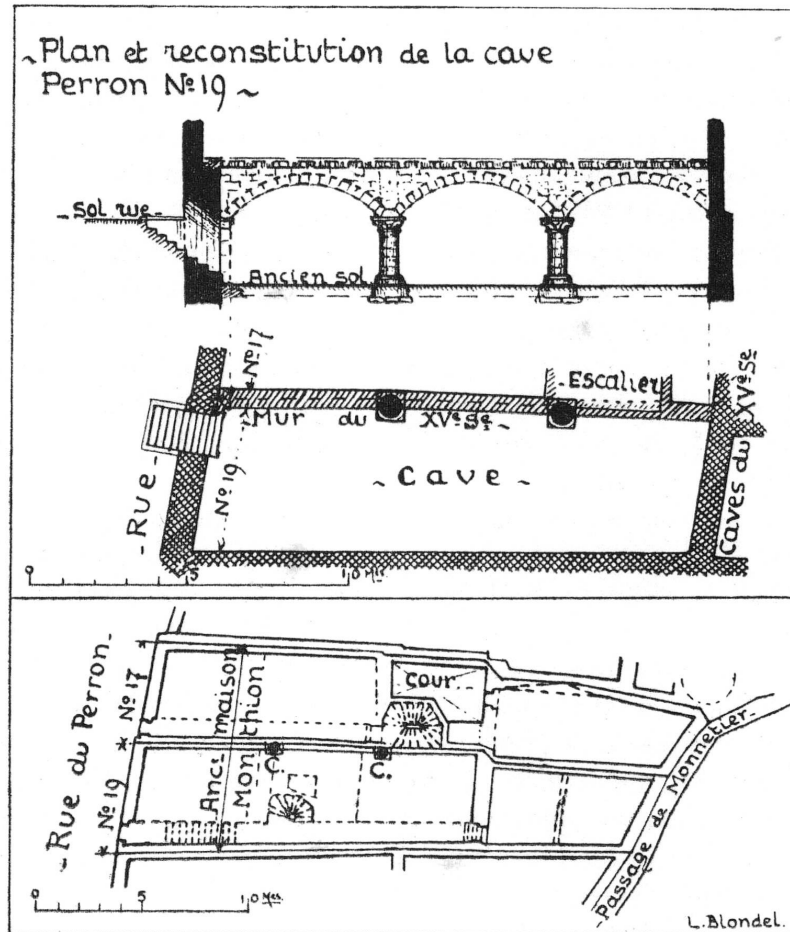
Plan et élévation de la cave n° 19 au Perron.
